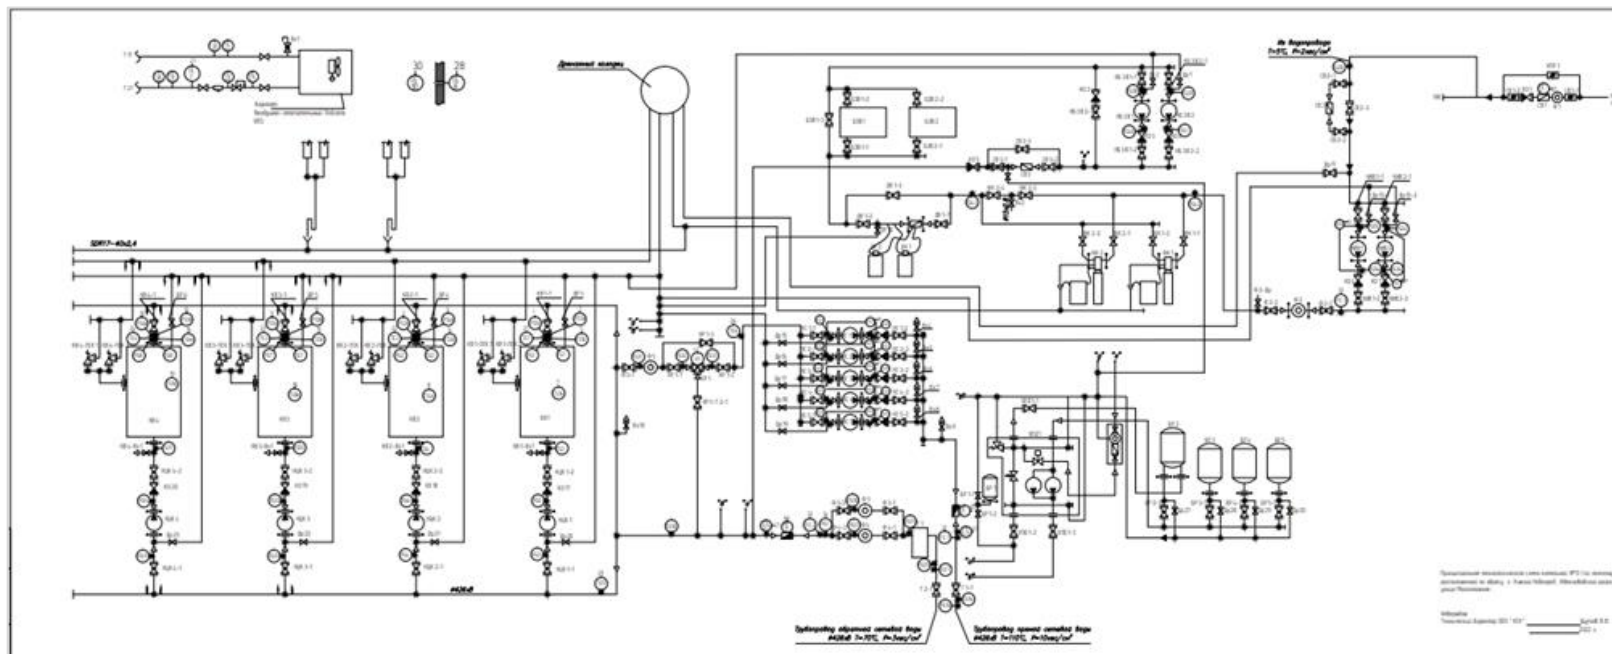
Тепловая схема котельной Малоэтажная, 31а
